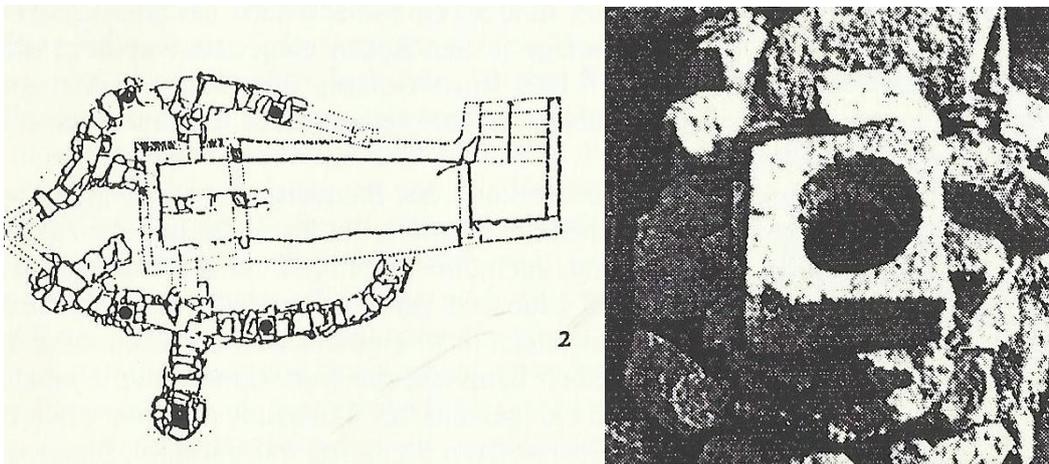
Pfalz Werla: Grundriss (links), Auslassöffnung (rechts) (Aus: Bingenheimer, 1998, S.74 und S.76.)
